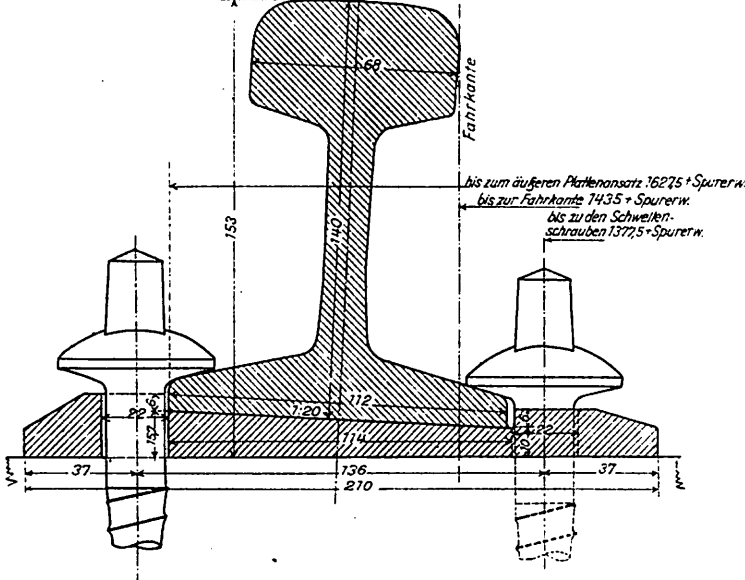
Spannplattenbefestigung. (1 : 2,5) (Querschnitt A B der Abb. 4.)
